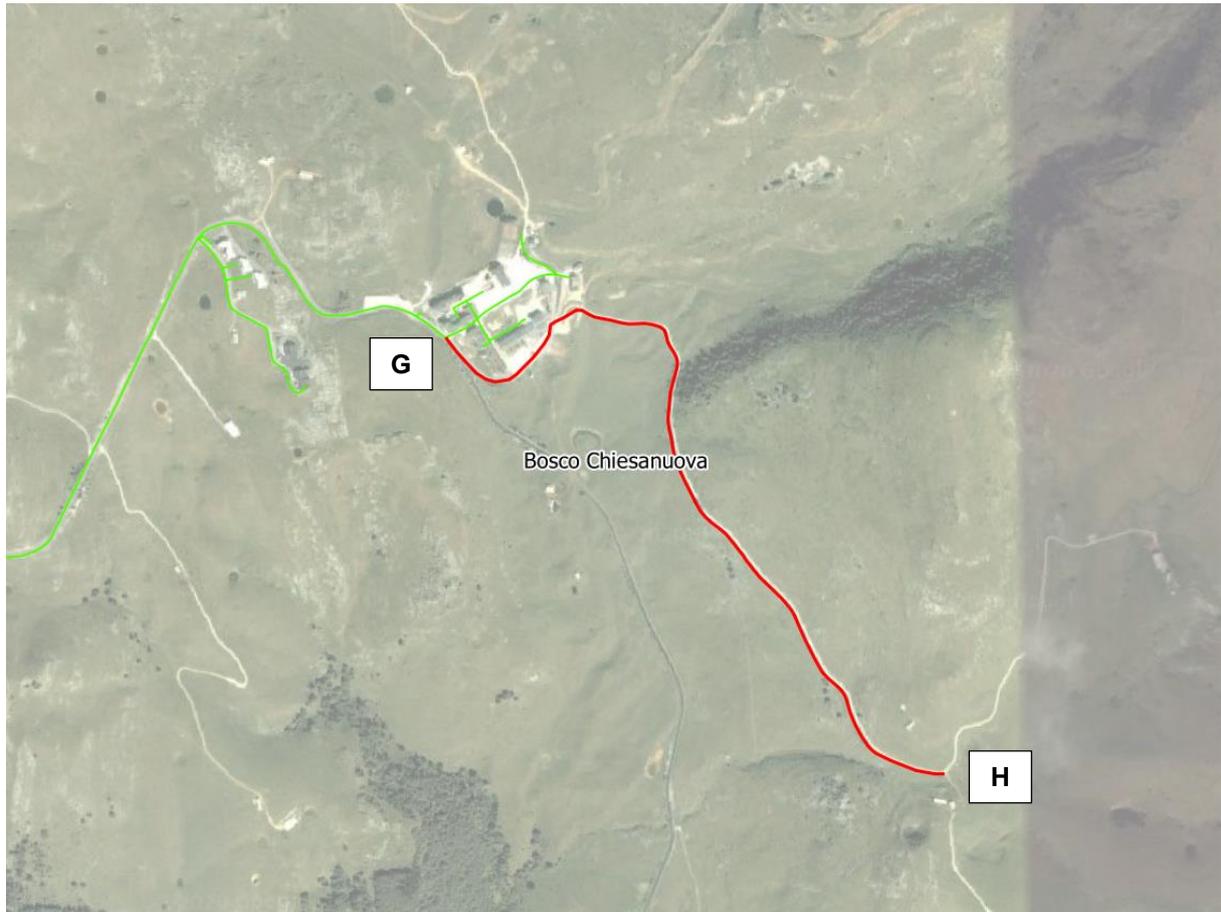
Planimetria generale del tracciato GH. In rosso il tracciato di progetto, in verde la rete esistente.
